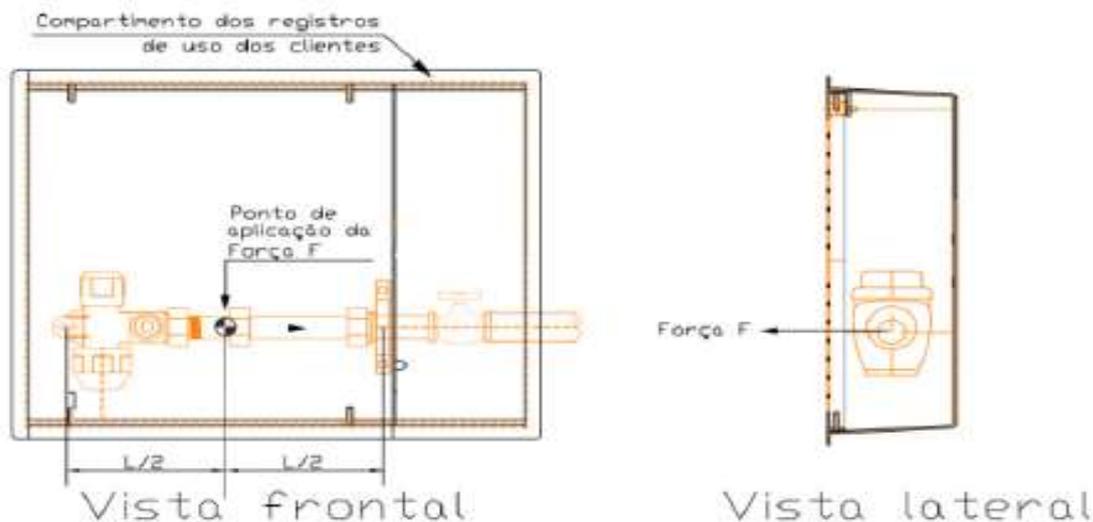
Esquema de montagem do corpo-de-prova no dispositivo de ensaio.
